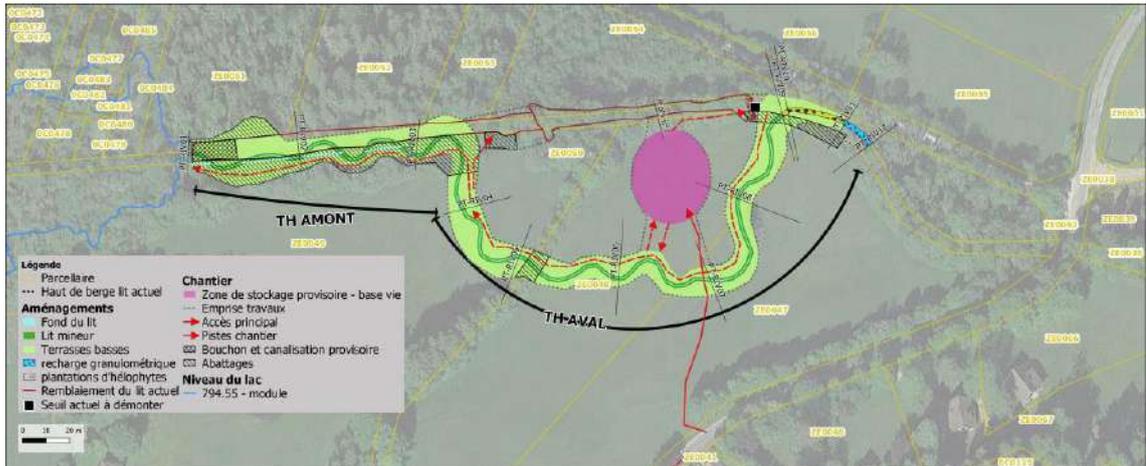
Localisation des zones d'installation de chantier et pistes d'accès (source : hydratec)
